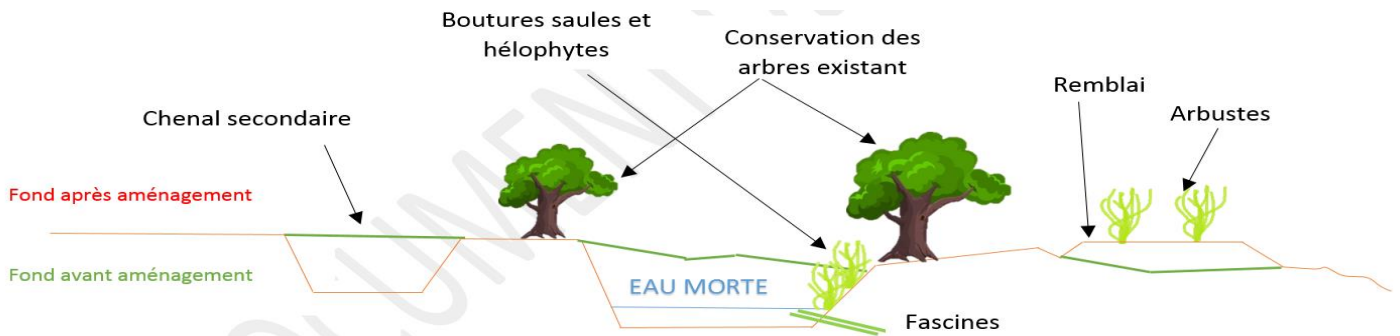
Coupe type des travaux à l'entrée du marais de Giez, © CCSLA
